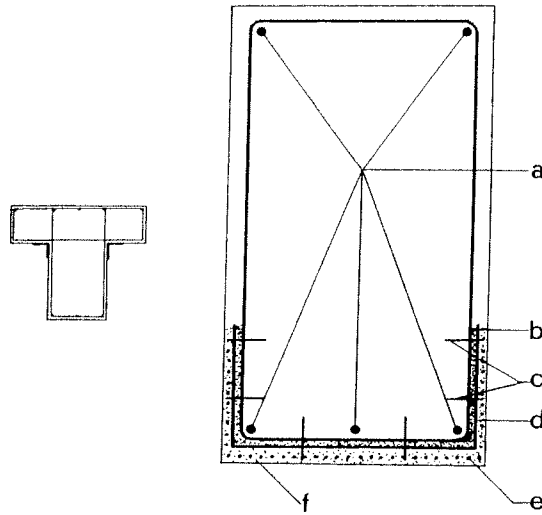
Consolidamento delle travi: *a*, armatura esistente; *b*, collante strutturale; *c*, chiodi sparati; *d*, piastra d'acciaio ad U; *e*, rete metallica; *f*, conglomerato cementizio.
